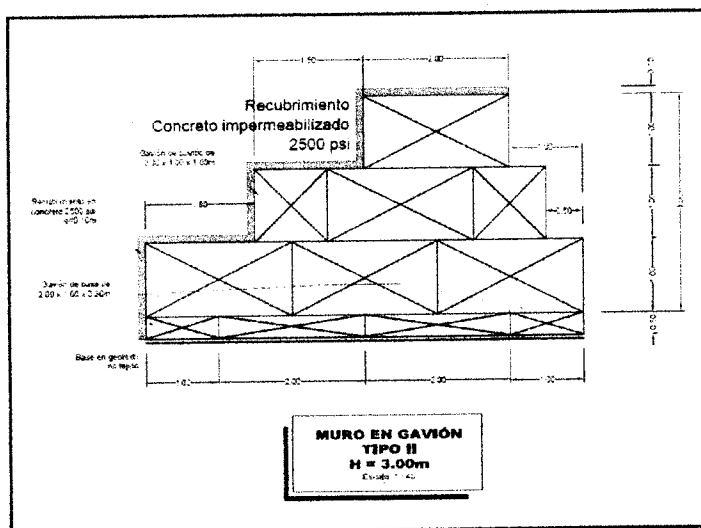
Muro Gavión tipo II y detalle dentellón (Protección para Socavación e inundación)
